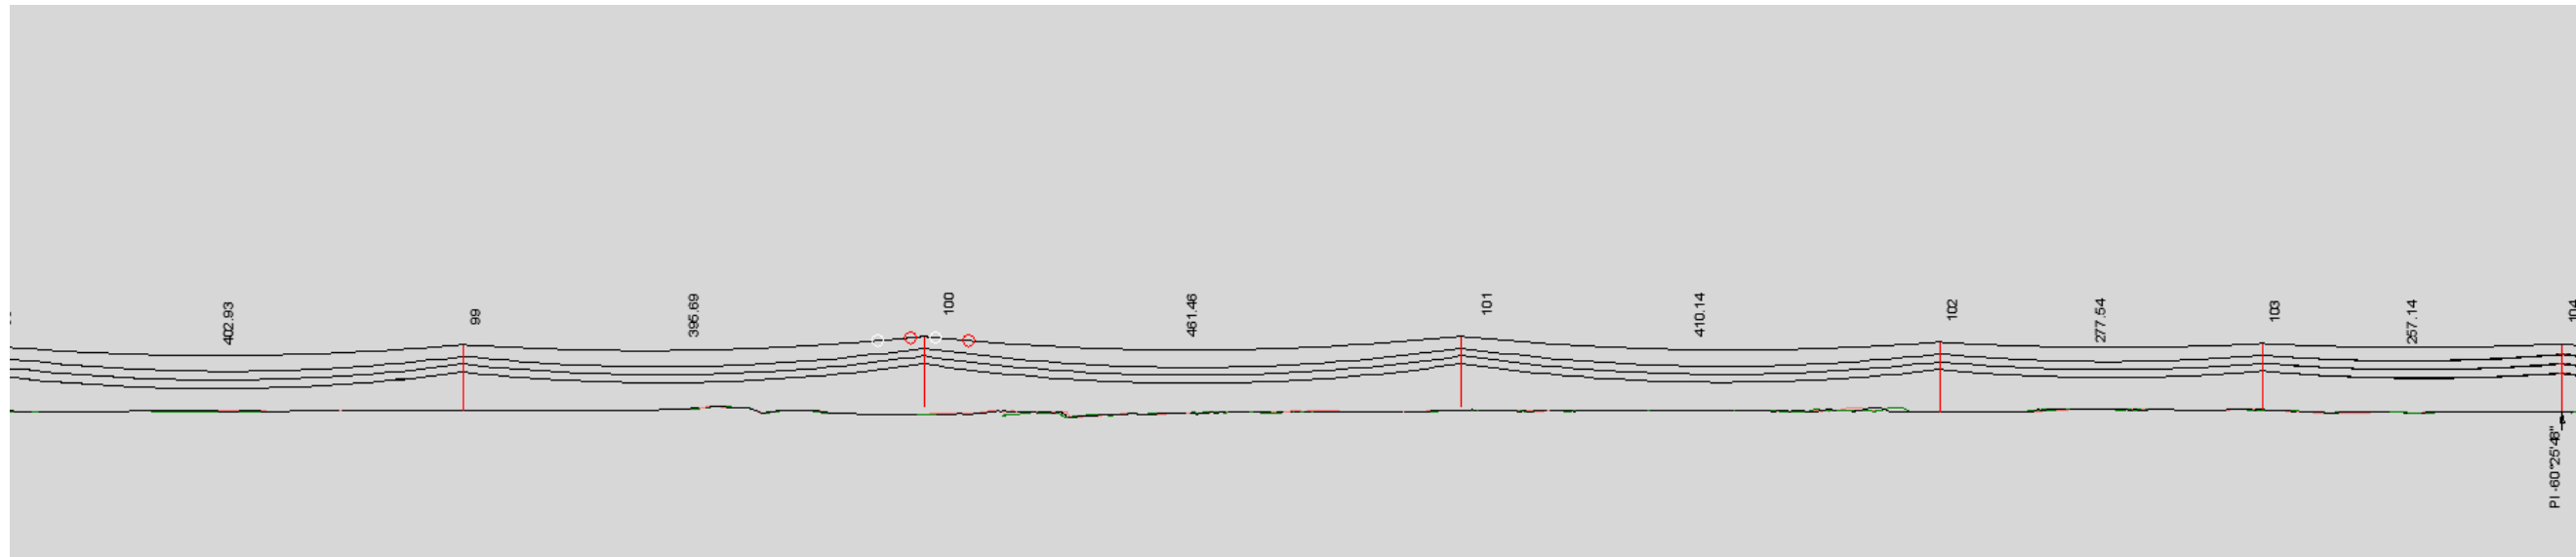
Sezione/profilo schematico del progetto "Autorizzato" (H tot sostegni attraversamento 55-66m)
